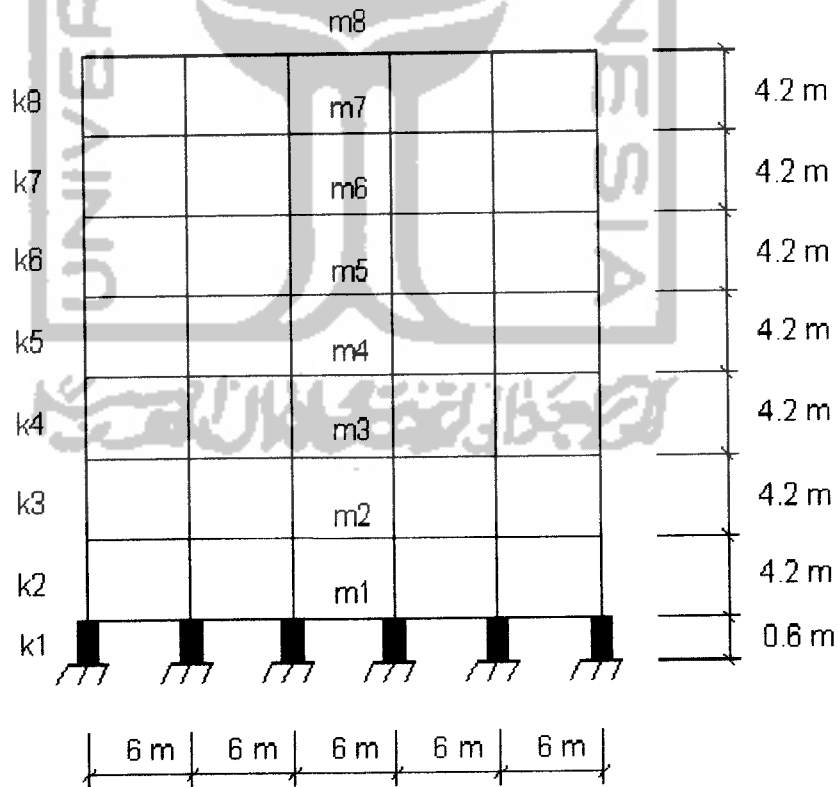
Pemodelan struktur beton bertingkat 8 tanpa *Base isolation
